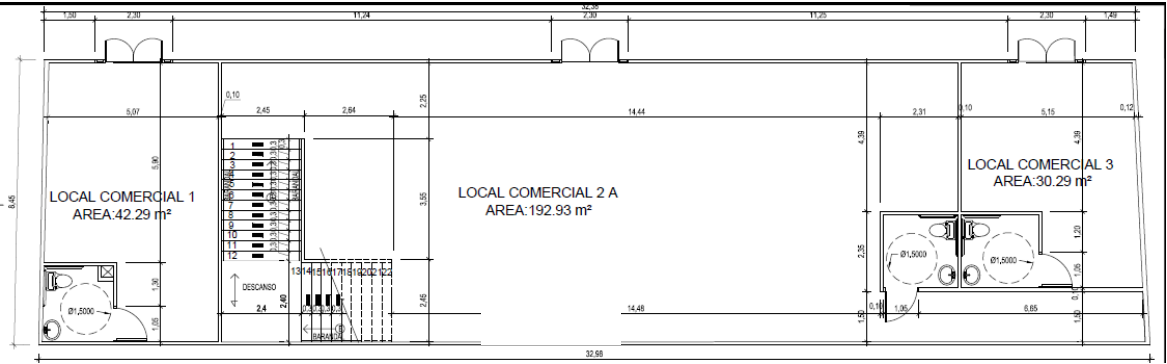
Planta Arquitectónica nivel 100 (Locales Comerciales 1, 2A y 3).
